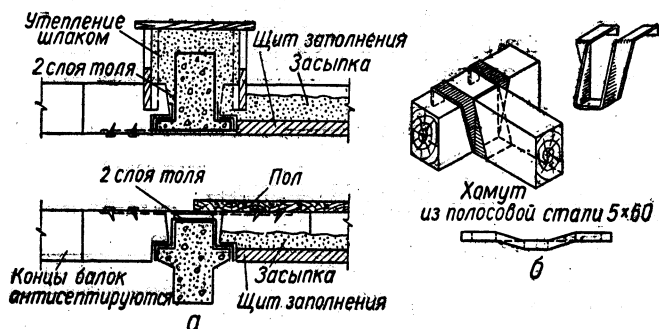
Опираие балок на железобетонные прогоны (а) и подвеска балок на хомуте (б).
